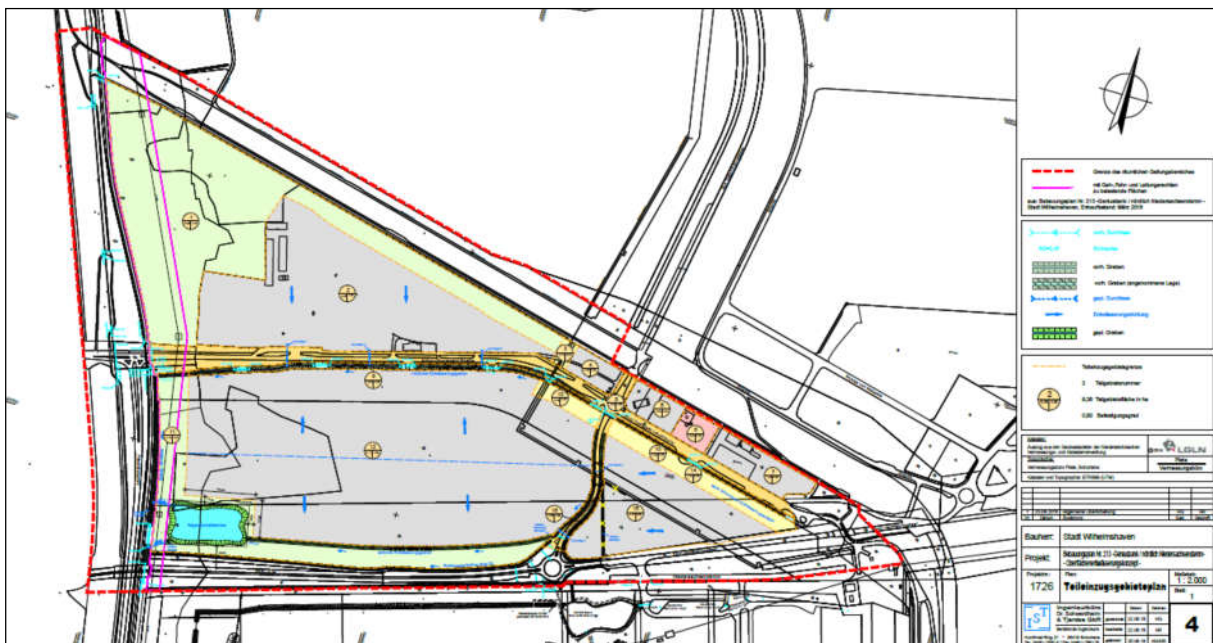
Teileinzugsgebietsplan aus dem Oberflächenentwässerungskonzept (IST)
